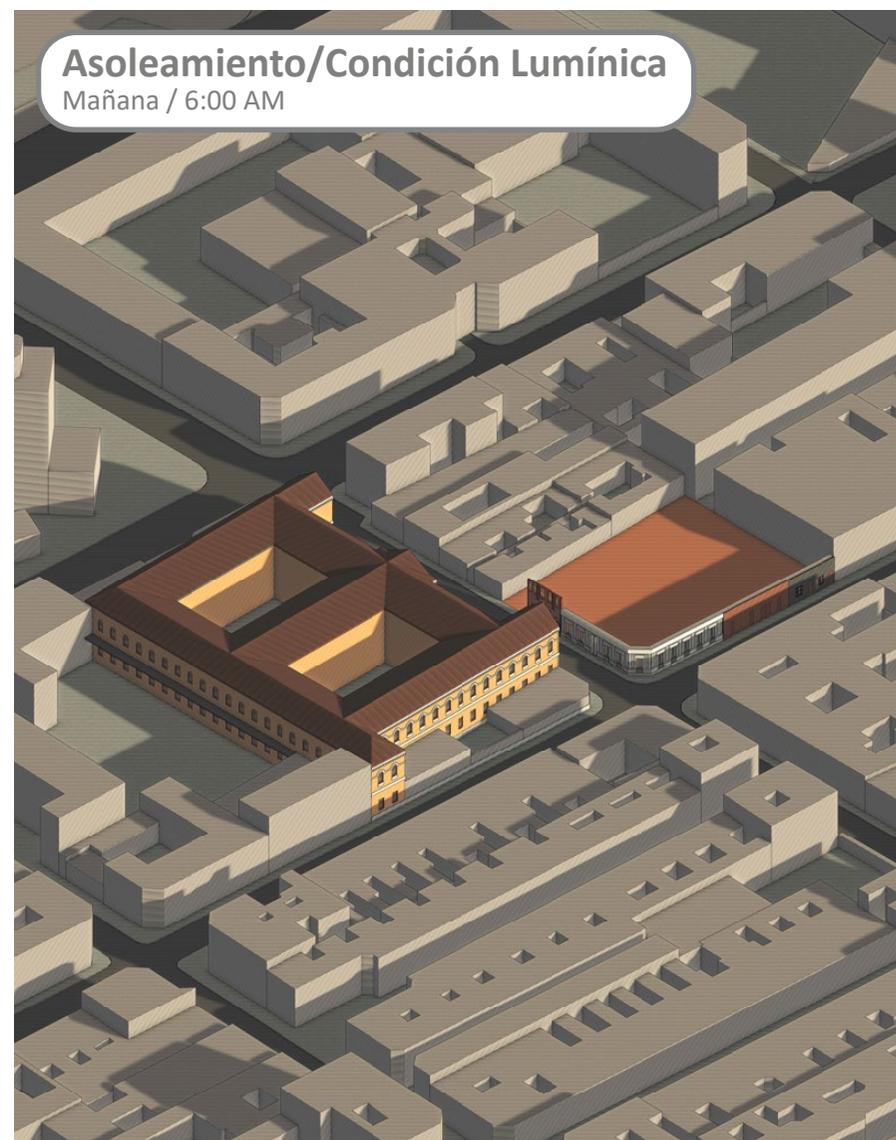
Render, Esquema de asoleamiento terreno escogido.
